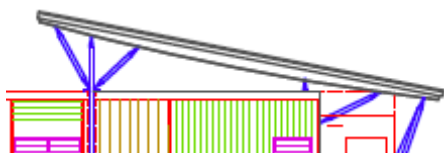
Exemple de sur toiture ventilée sur immeuble d'habitation - Architecte GAZUT - Maître d'Ouvrage CBO - technique adaptable à la Maison à toiture terrasse
